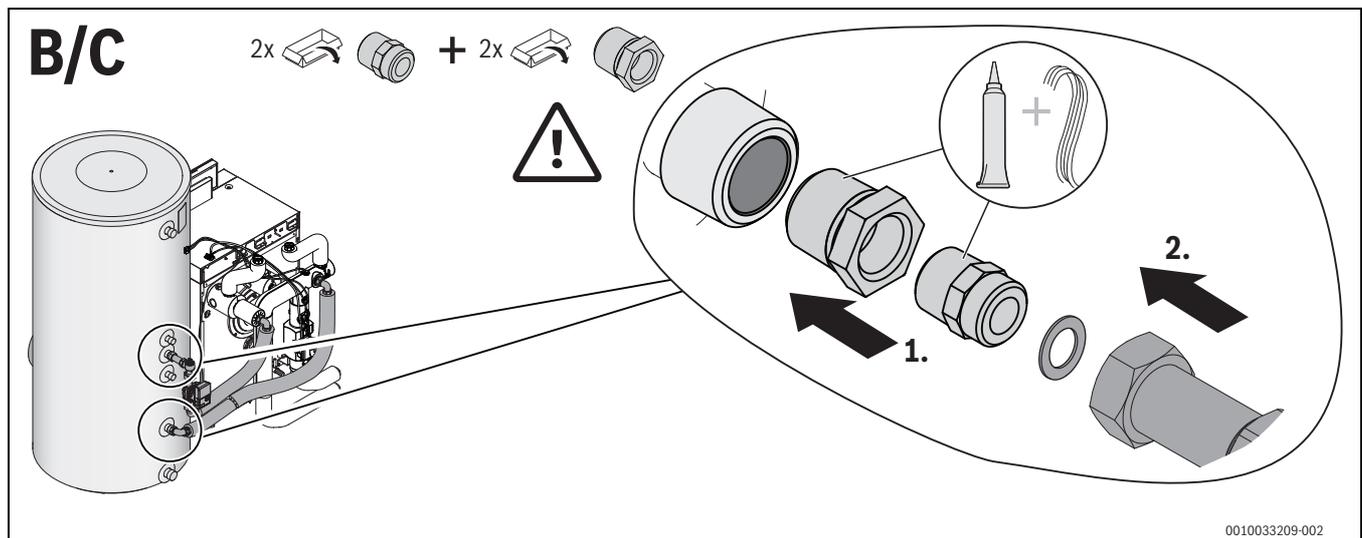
Installazione del collegamento di un bollitore verticale, variante B e C
